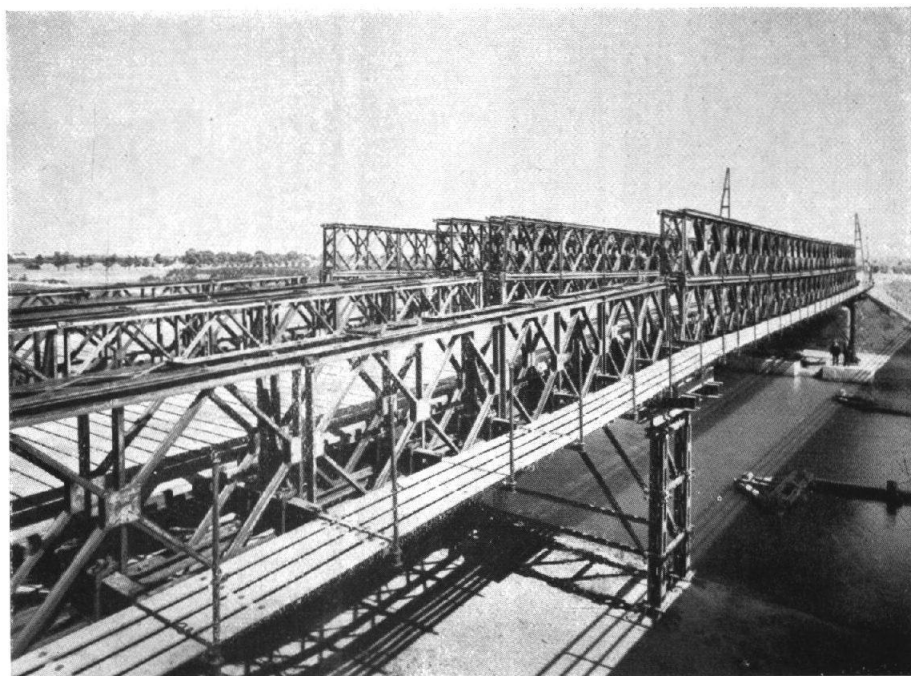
Ponts Bailey sur le canal Albert à Hérenthals (route d'Oolen).
